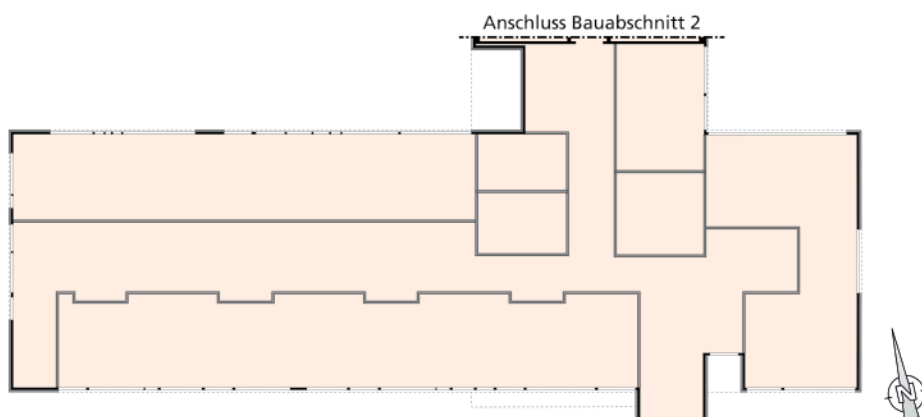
Erdgeschoss-Gebäudeumriss des Neubaus, Bauabschnitt 1
